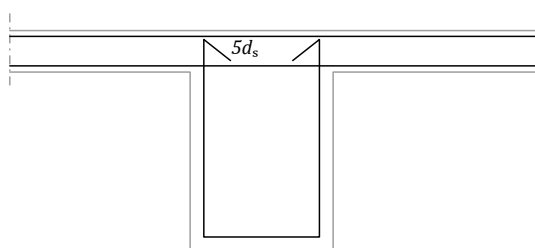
Biegeform oben offener Bügel und Gurtbewehrung
